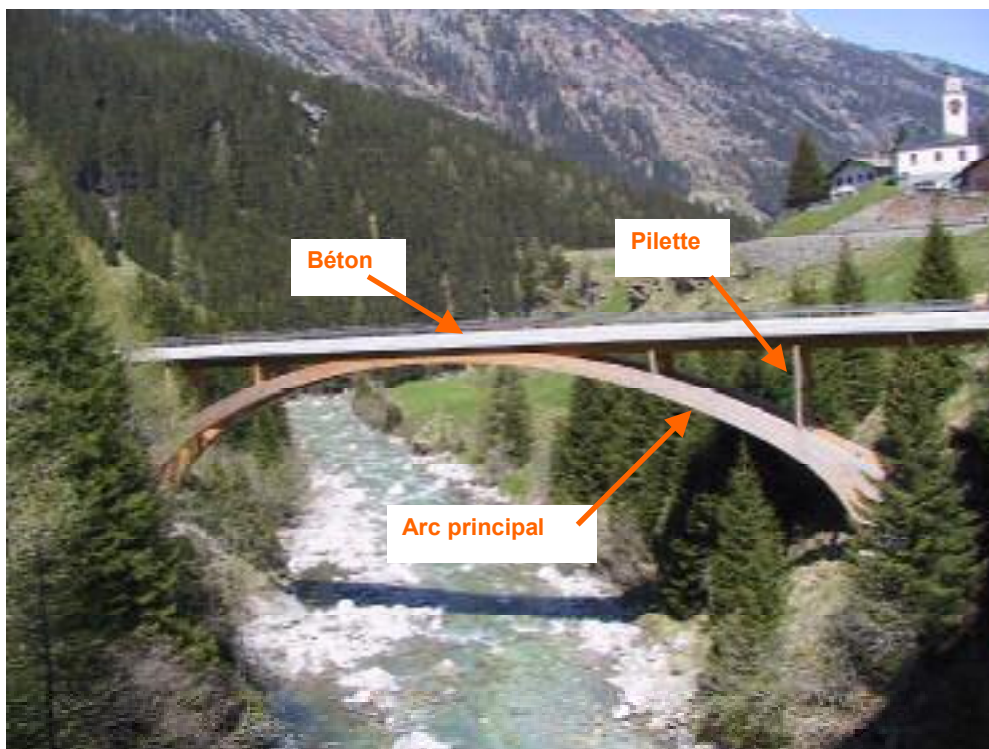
Pont en arc à Innenferrera construit en 1998, de 60m de longueur. Ce pont allie le bois (arcs) et le béton (dalle), connectés entre eux mécaniquement.
